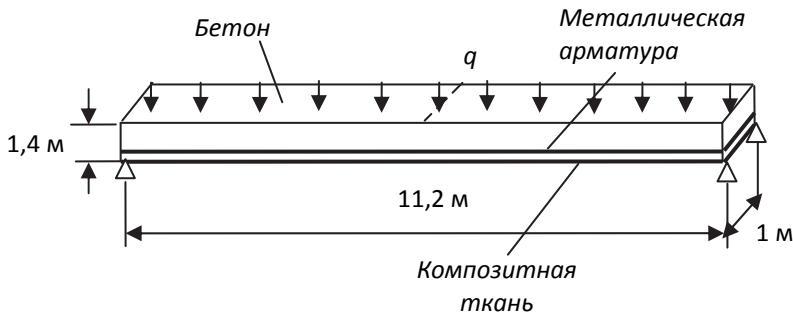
Фрагмент железобетонной плиты, усиленной композитной тканью
